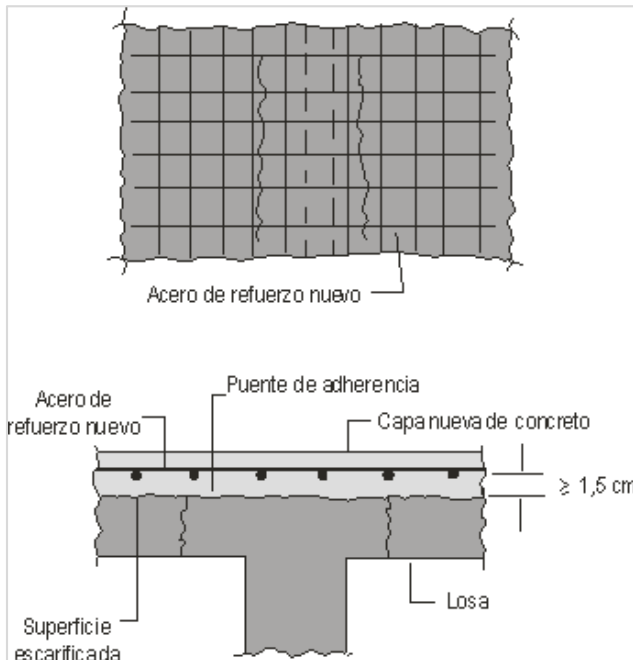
Refuerzo a flexión en losa de hormigón.
